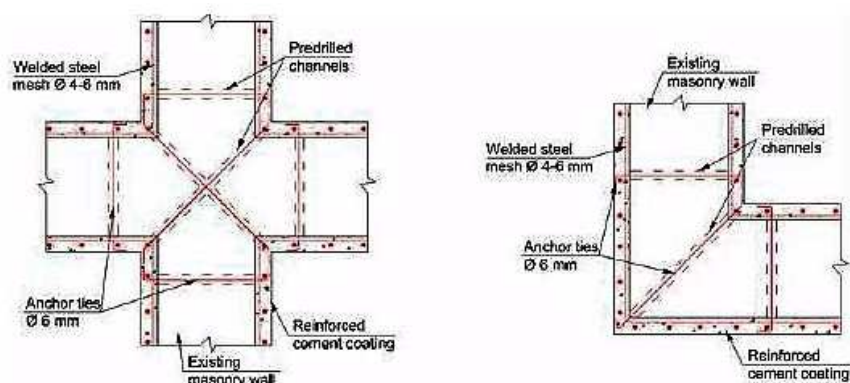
Reforço de ligações por encamisamento com betão armado.[20]
